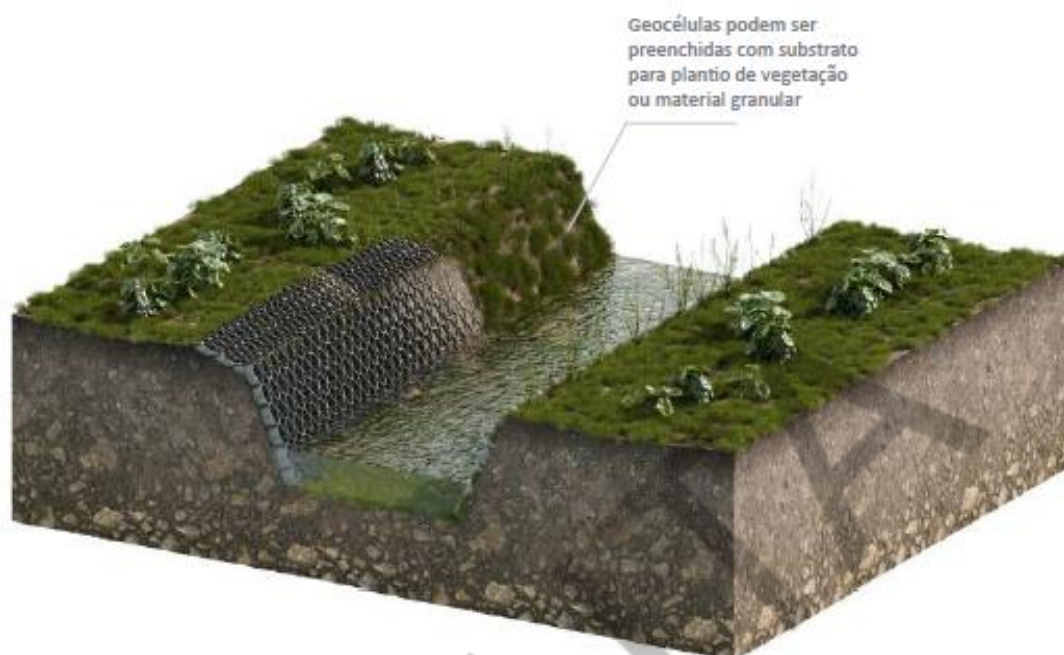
Contenção estrutural em Geocélulas (Fonte: Guajava, 2023 apud Sandre et al., 2024).
